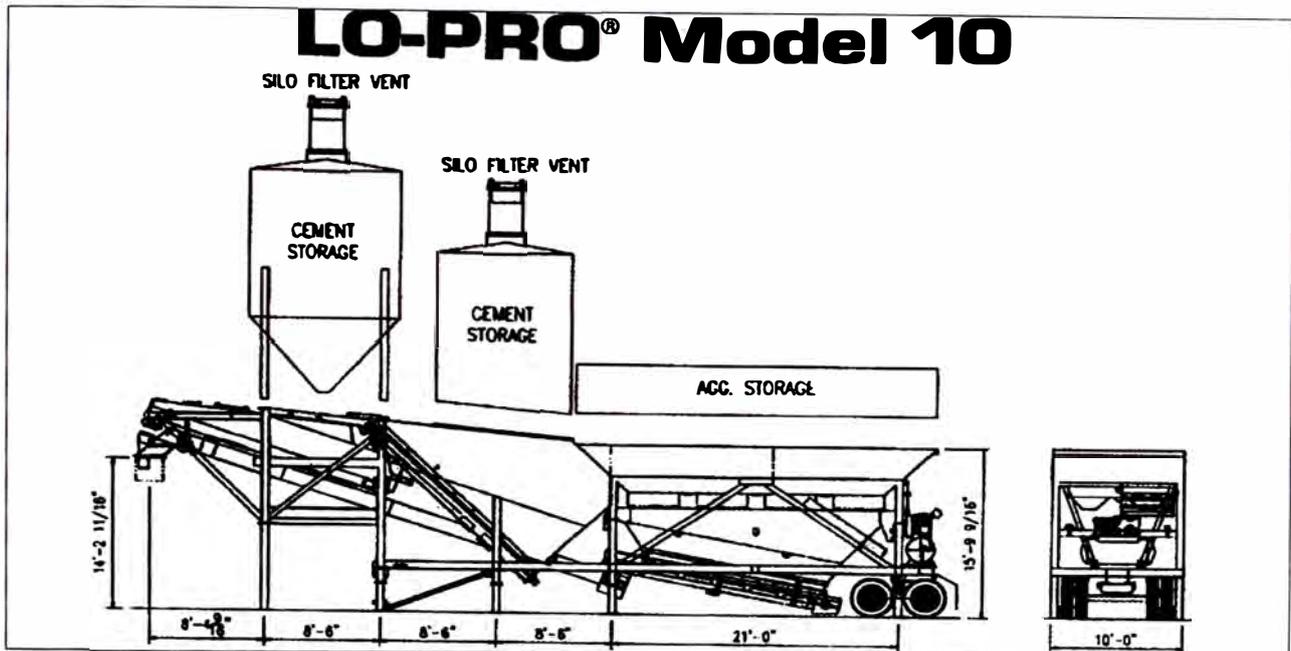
Dimensiones de Planta de Concreto CON-E-CO LO PRO 10 (Fuente: CON-E-CO)
